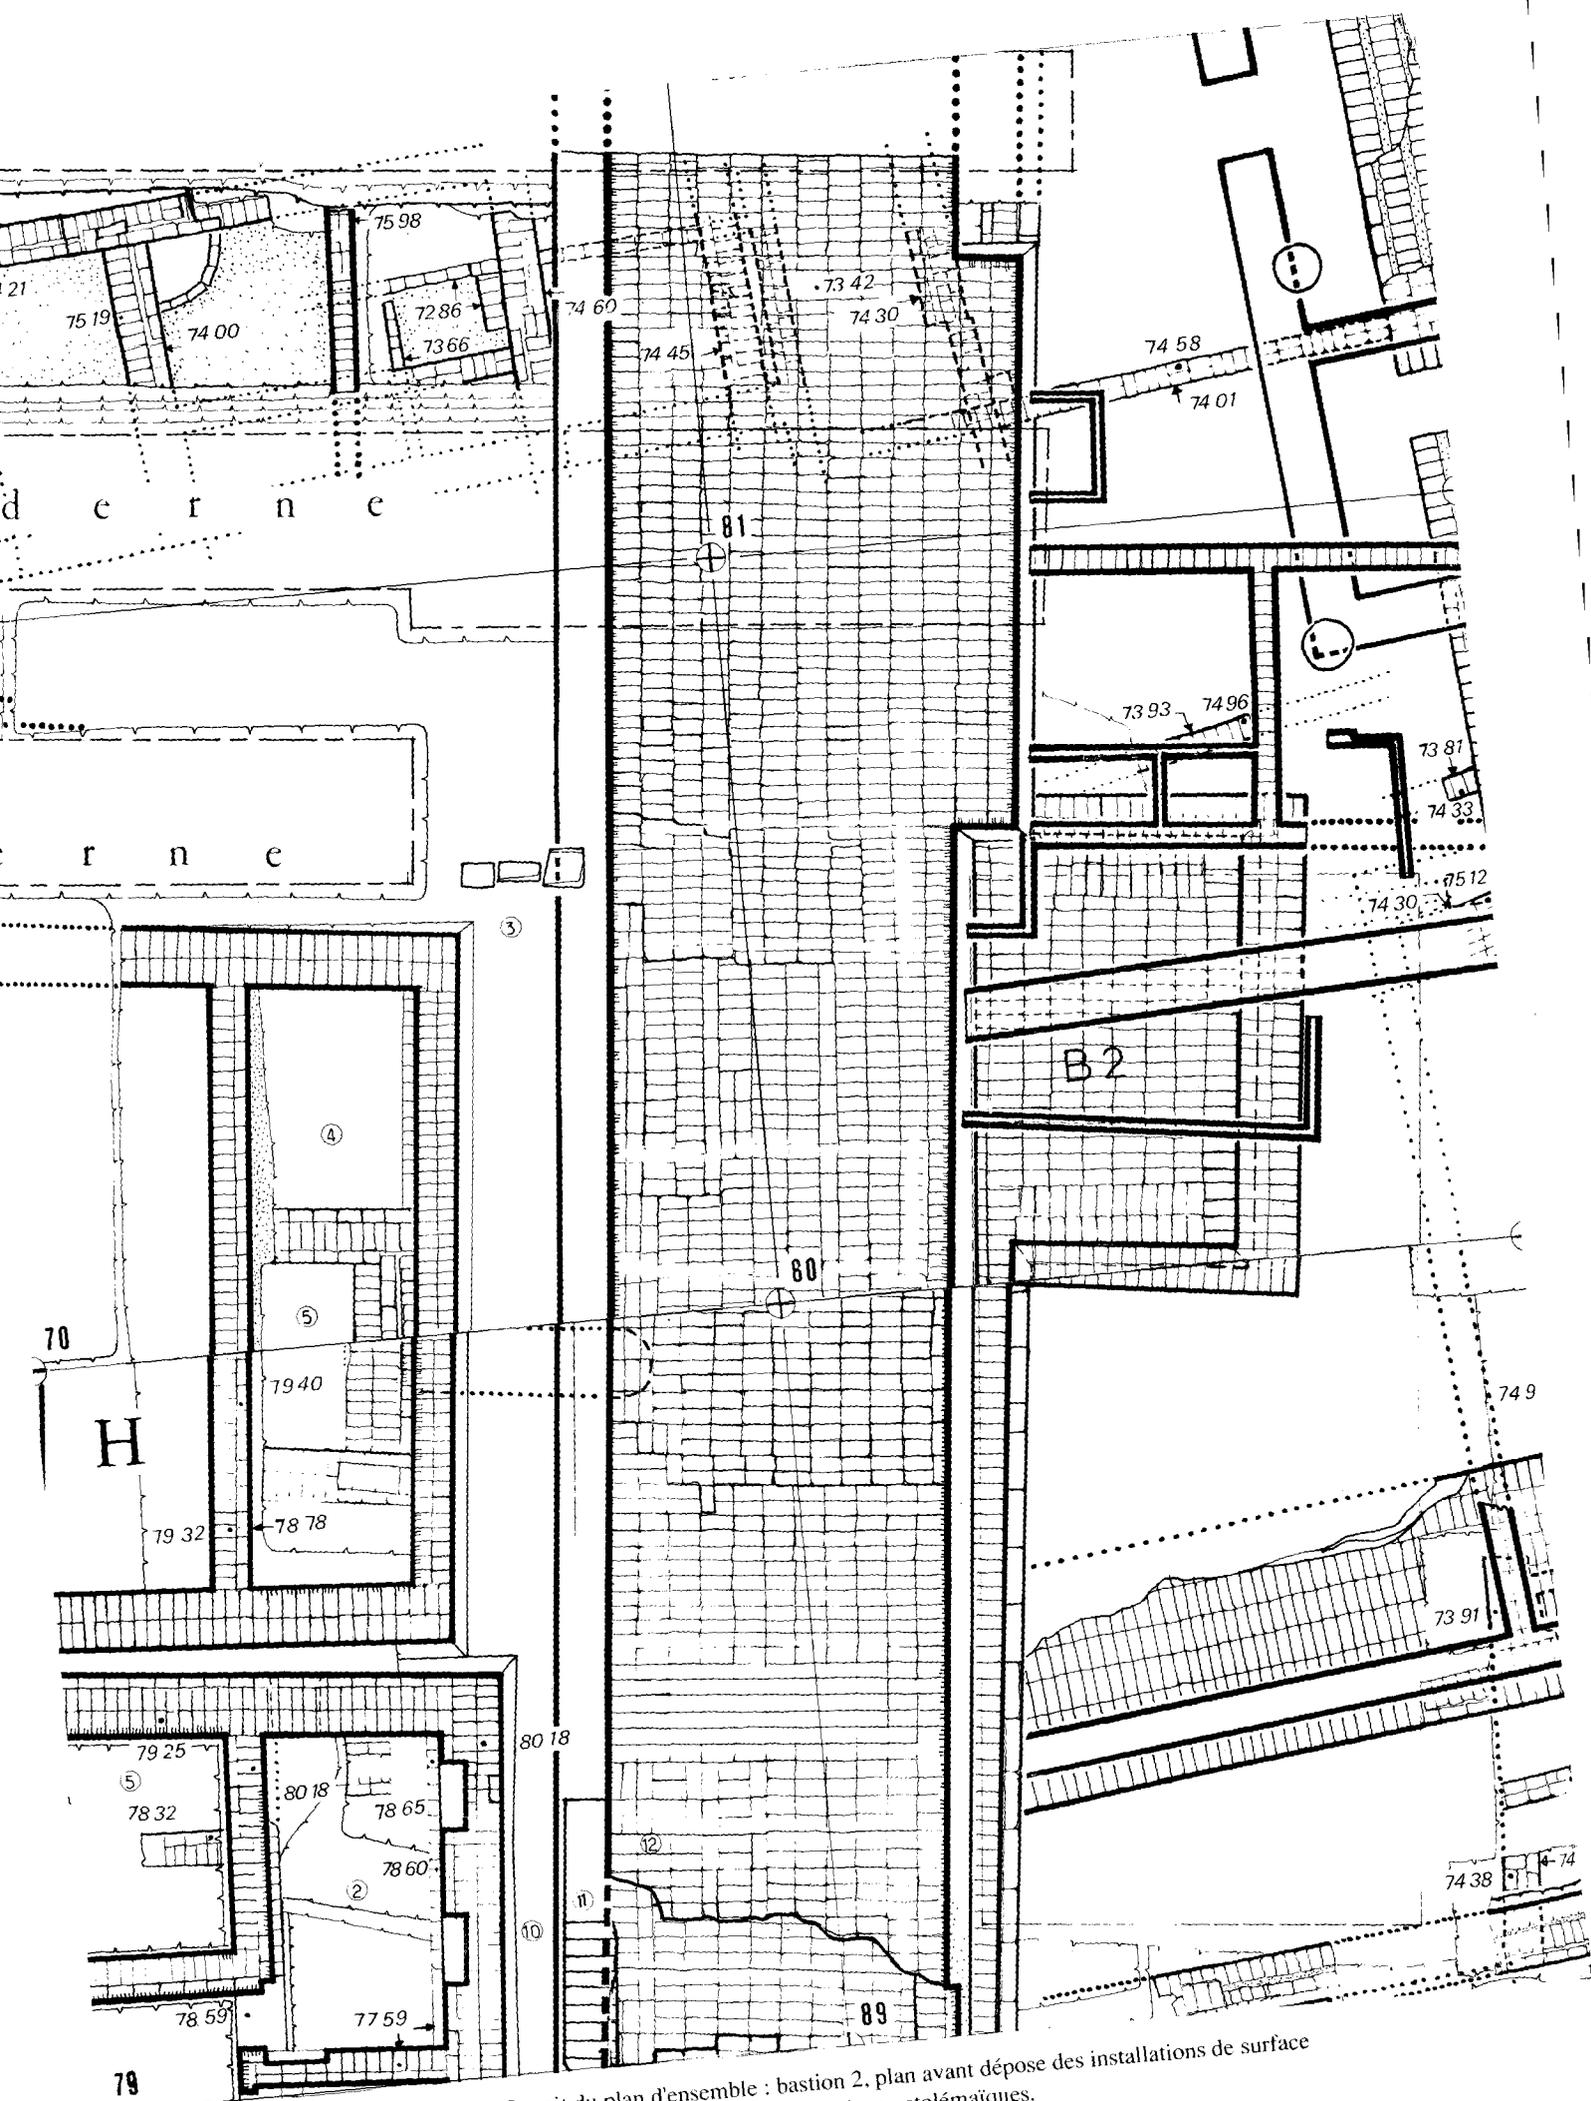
Extrait du plan d'ensemble : bastion 2, plan avant dépose des installations de surface à gauche des maisons ptolémaïques.
